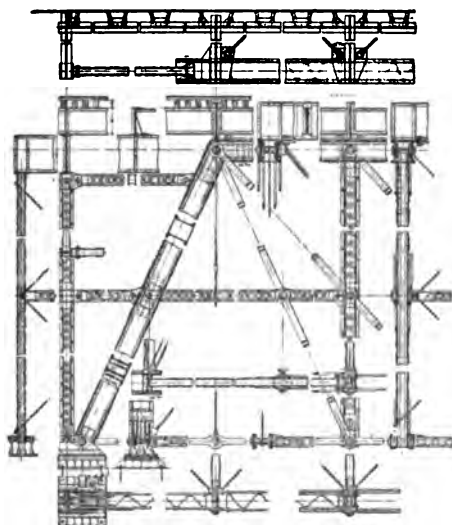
à 376. — Pont du Havre-de-Grâce. Travée de 146^m,30.
